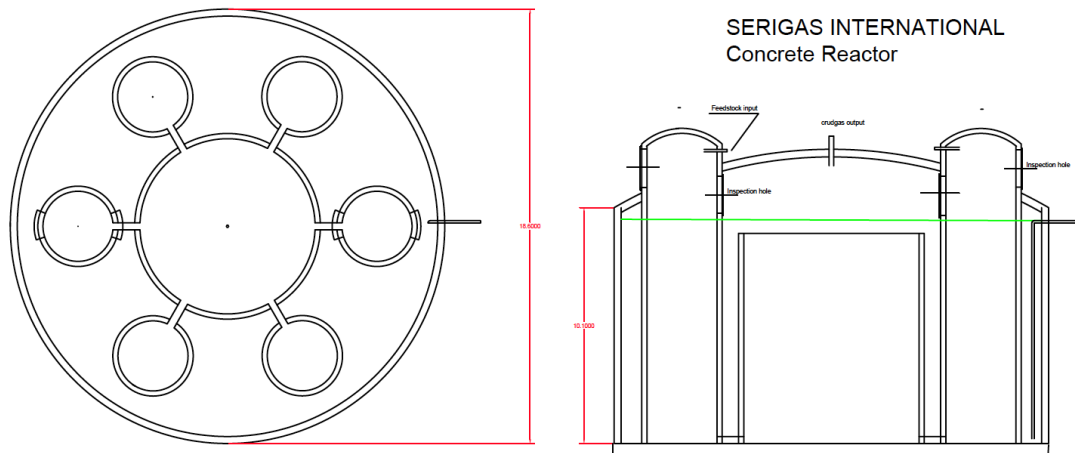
Silos imbriqués construits sur place - Source : Serigas
